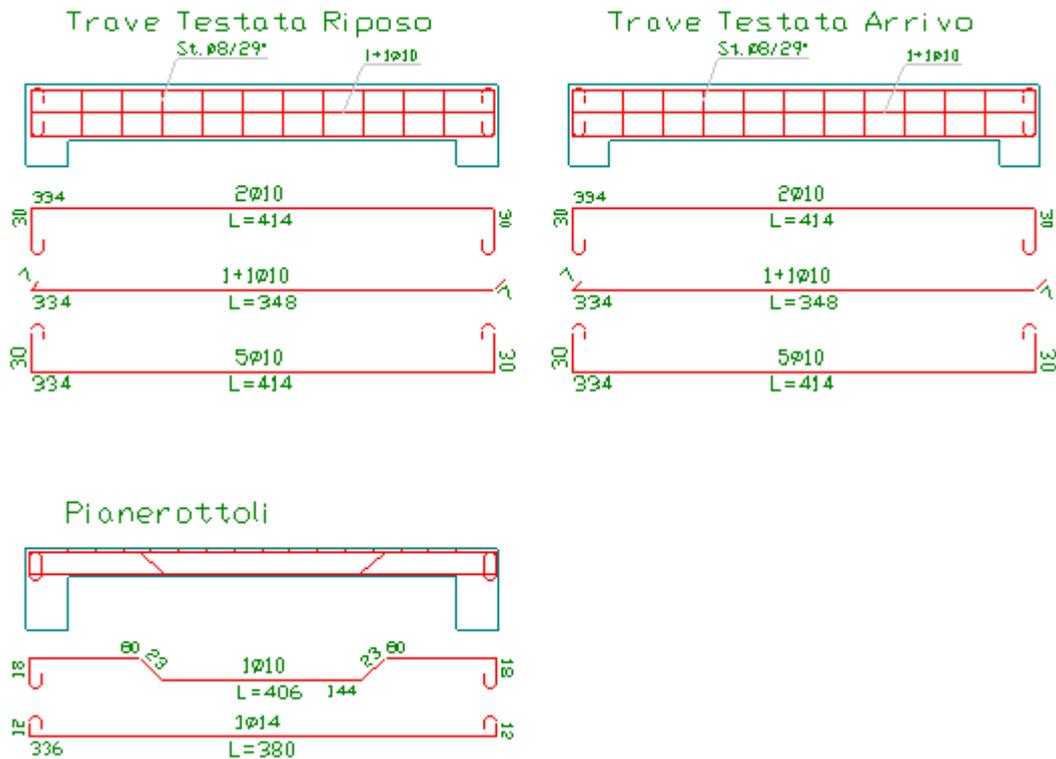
Disposizione armature travi di testata e pianerottolo.
